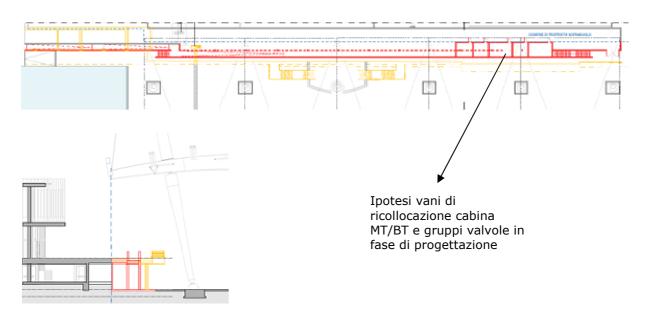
Planimetria e sezione di una possibile configurazione finale attualmente in fase di progettazione
